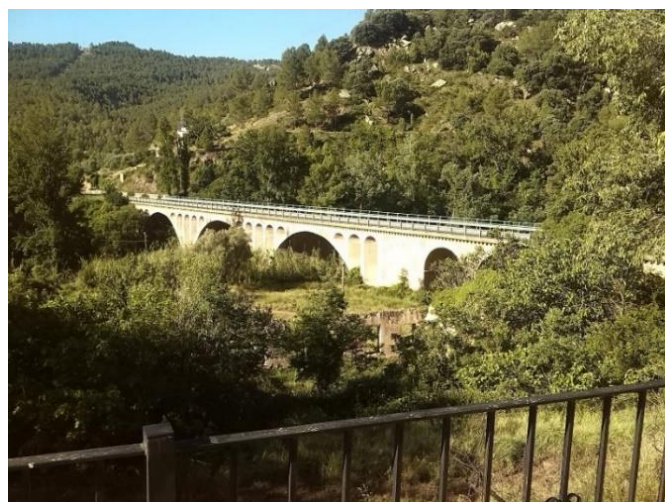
Puente sobre el Mijares CV-20, entre los Cantos y la Monzona (3)
